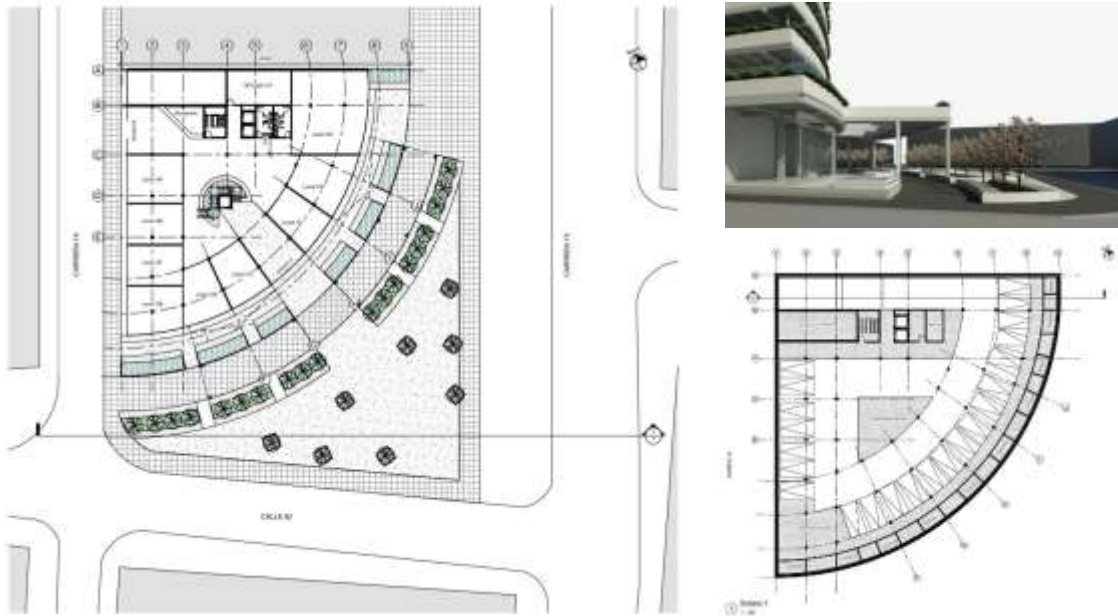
Planta Urbana y Planta Sótano Esc 1:200
